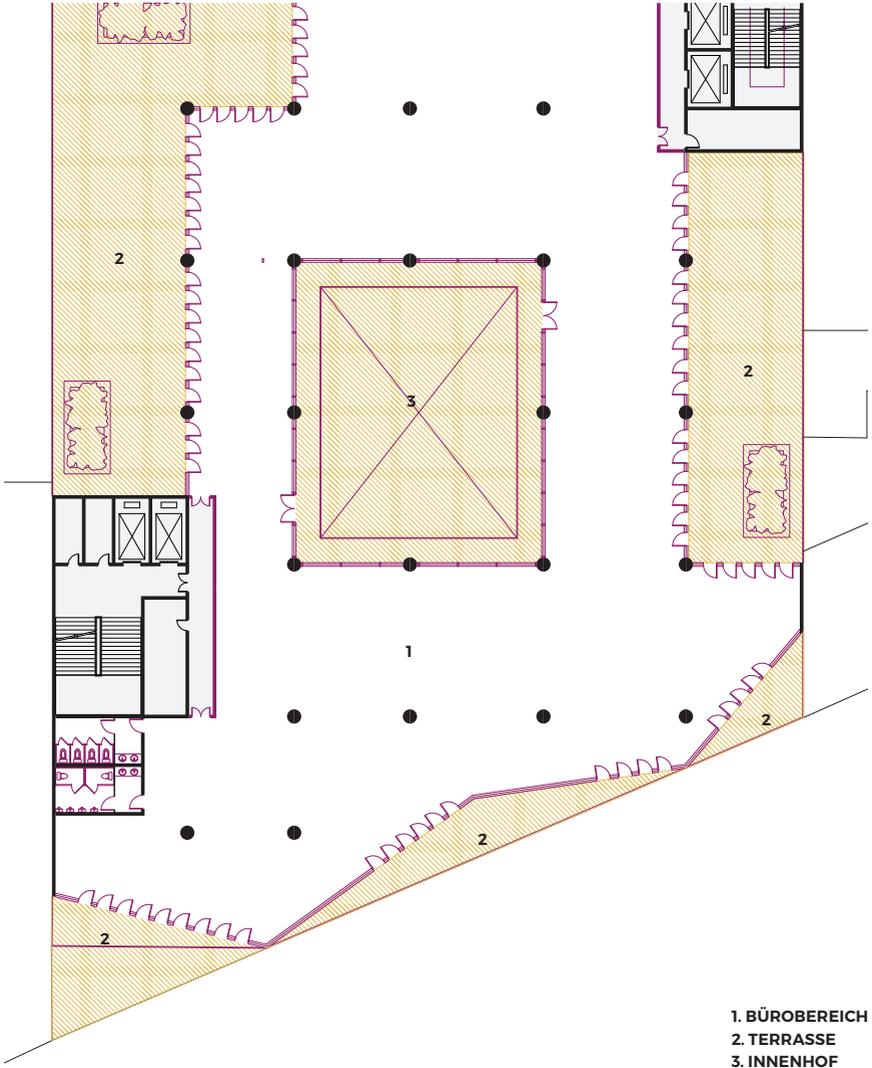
GrundrissAusschnitt 4.OG 1:500
